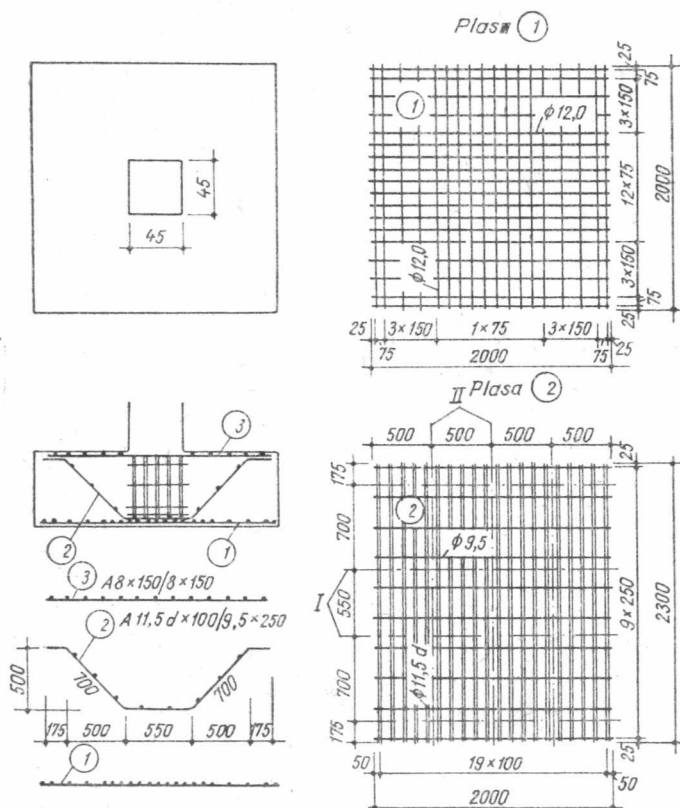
Armarea fundațiilor izolate cu plase sudate plane și îndoite:
